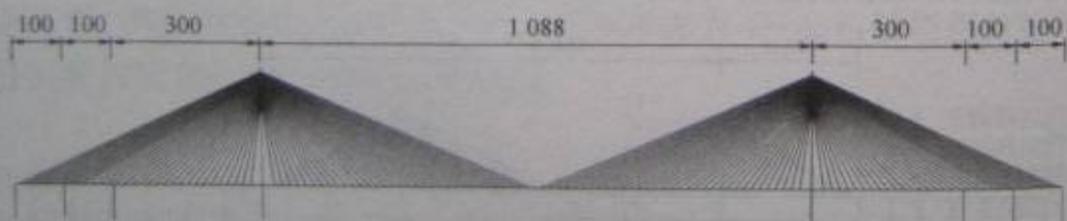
苏通大桥主桥桥跨布置(尺寸单位:m)
